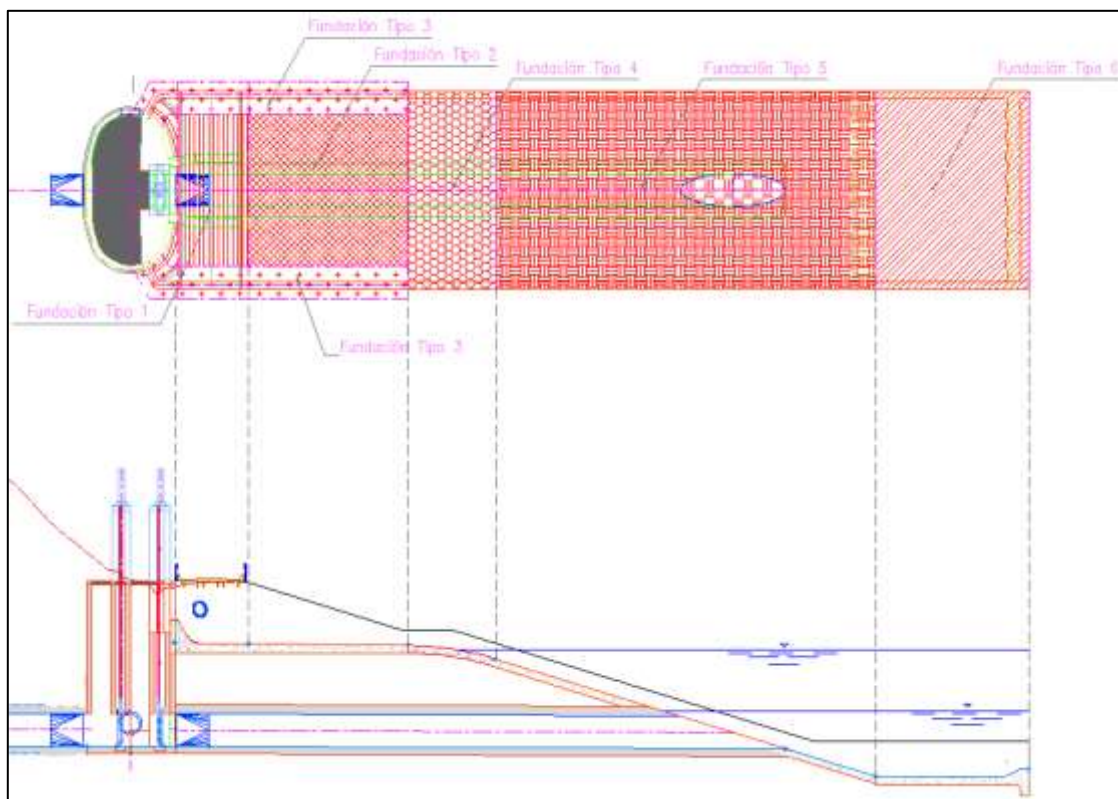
Definición de los tipos de cimentaciones en conjunto con el Área de Ingeniería Estructural
